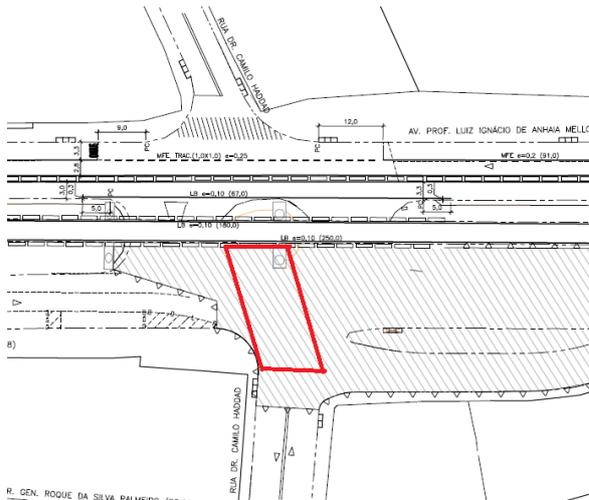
Locação em planta da região onde foi encontrada a ponte (Fonte: Metrô-SP)
